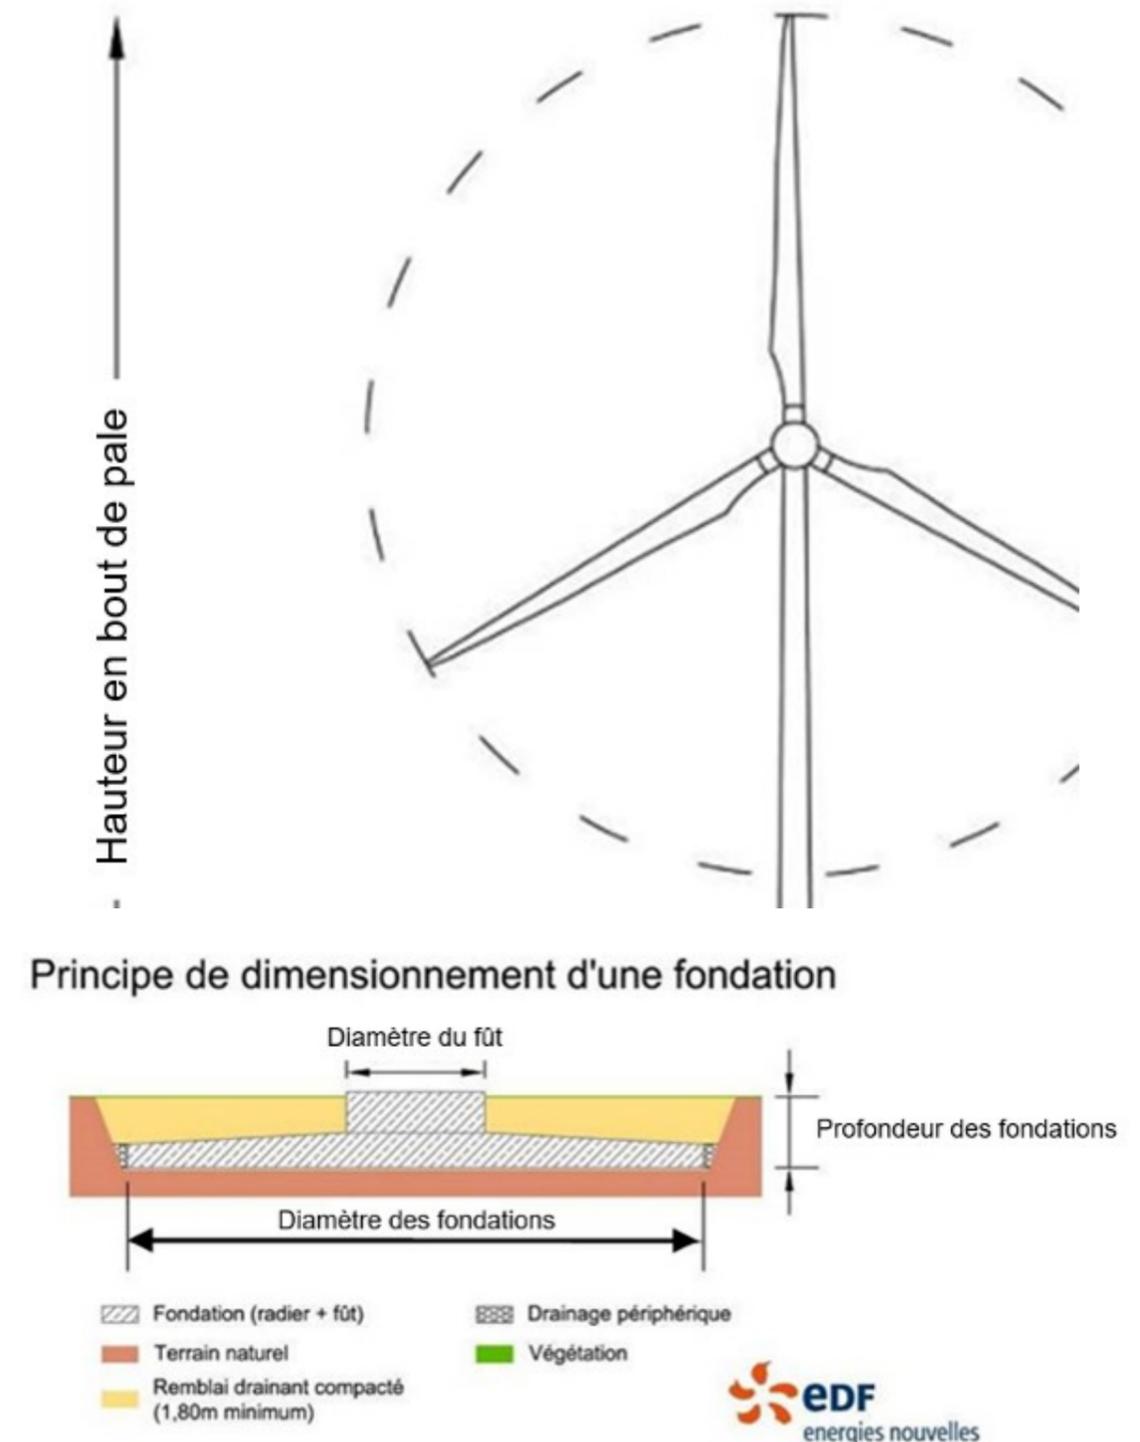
Principe de dimensionnement d'une fondation d'une éolienne
